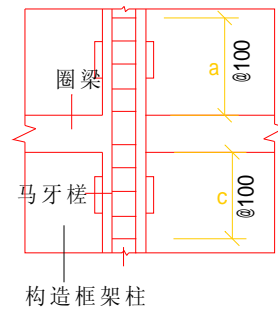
构造框架柱钢筋在楼层处的连接示意图
